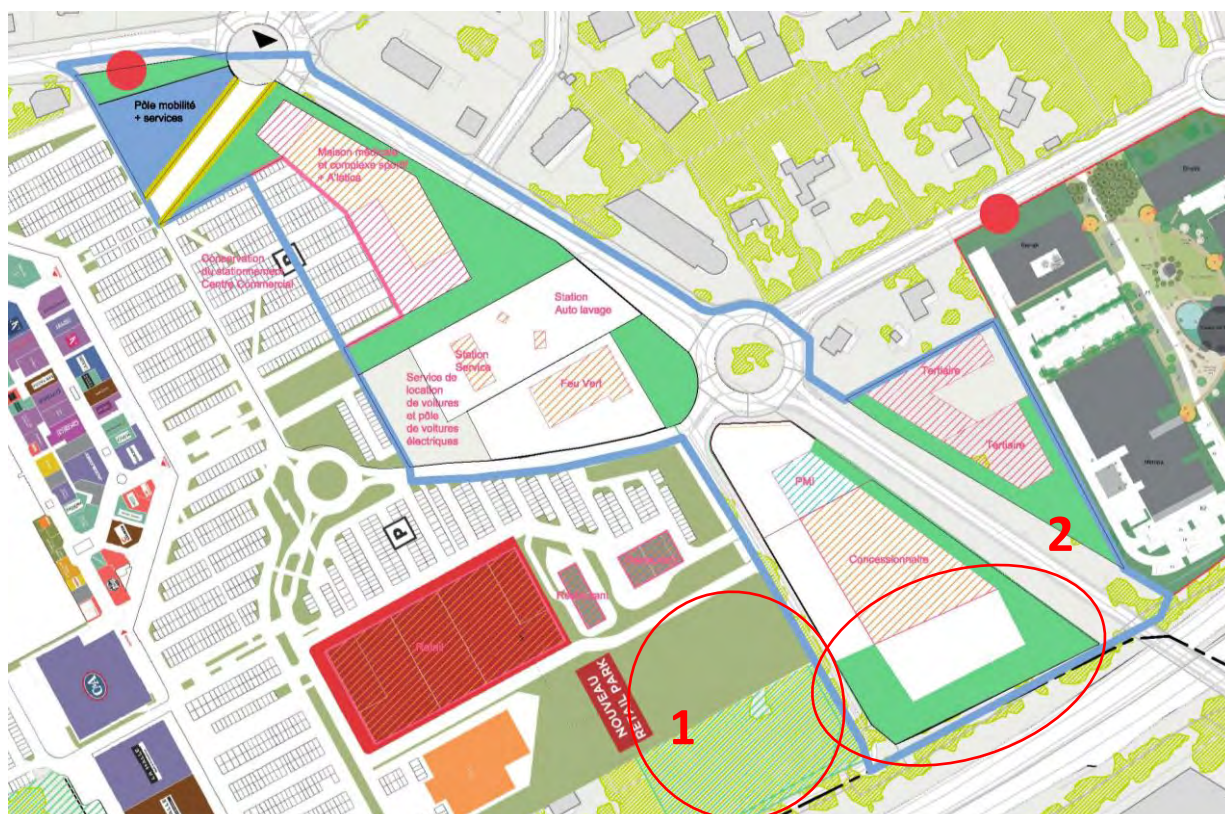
Plan d'aménagement retenu pour le secteur 10 Bois Bersol (20 juillet 2018)
